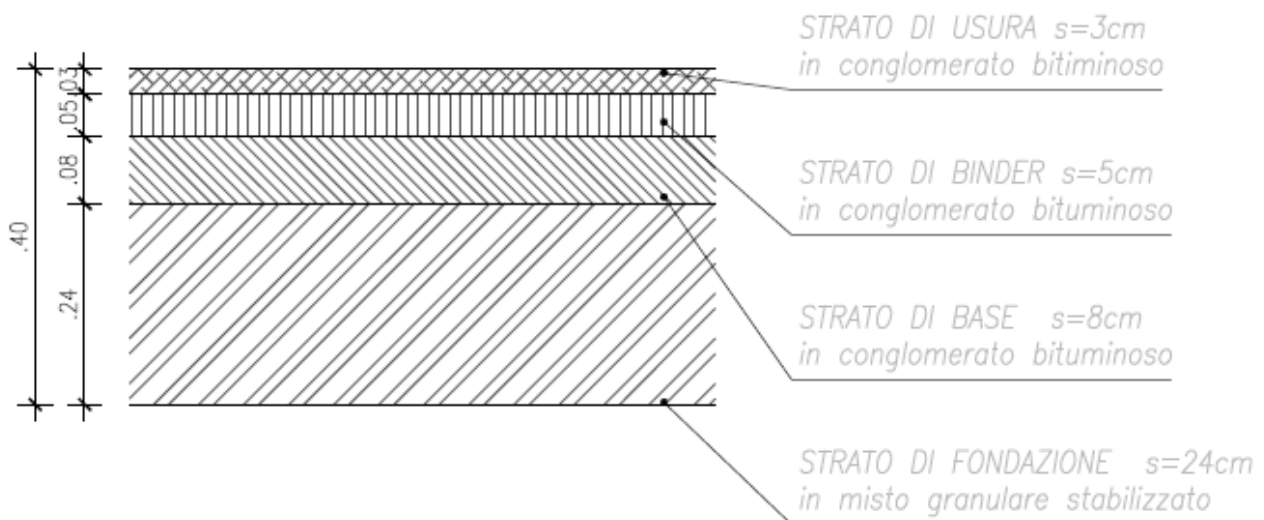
Pacchetto sovrastruttura stradale viabilità secondarie
